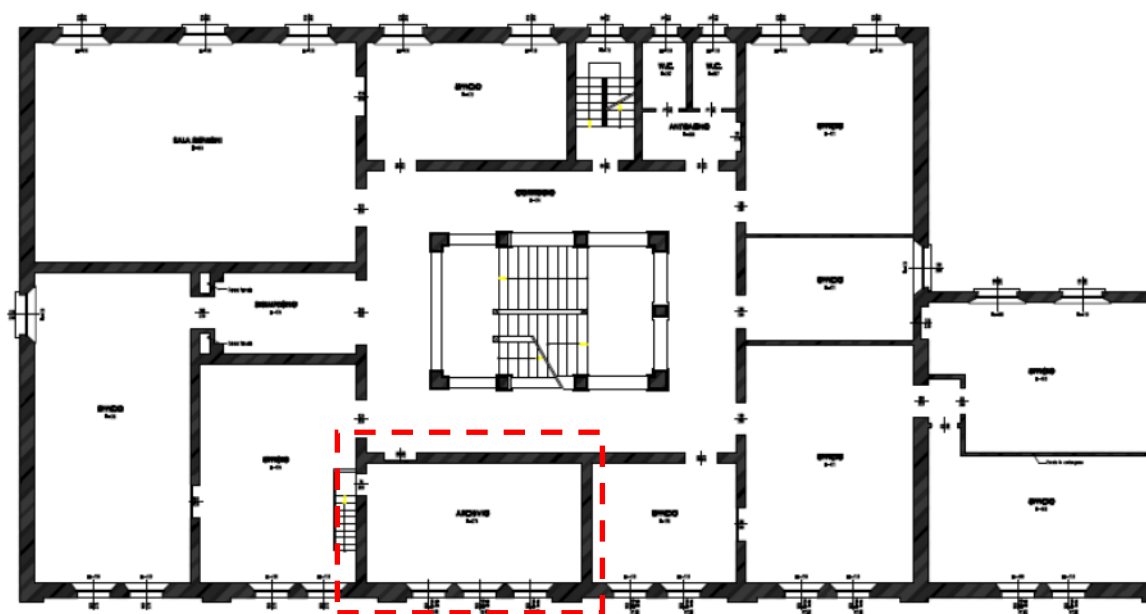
Pianta piano primo, con localizzazione del mezzanino
